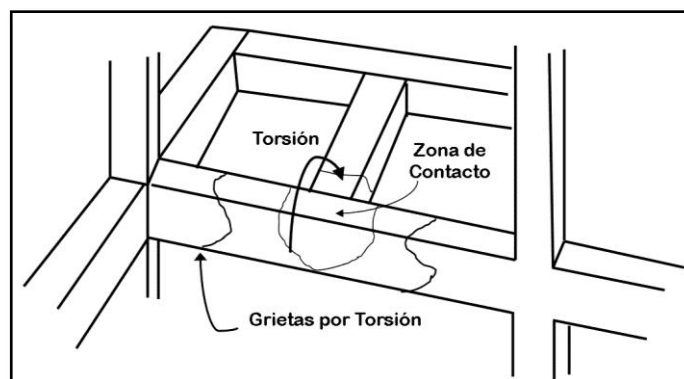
Fallas por Torsión en Vigas de Concreto Armado.
